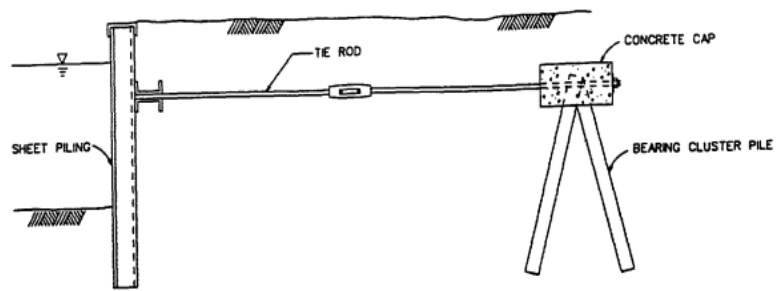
3 Sheet Pile Angkur Tie Rod and Anchor Wall
